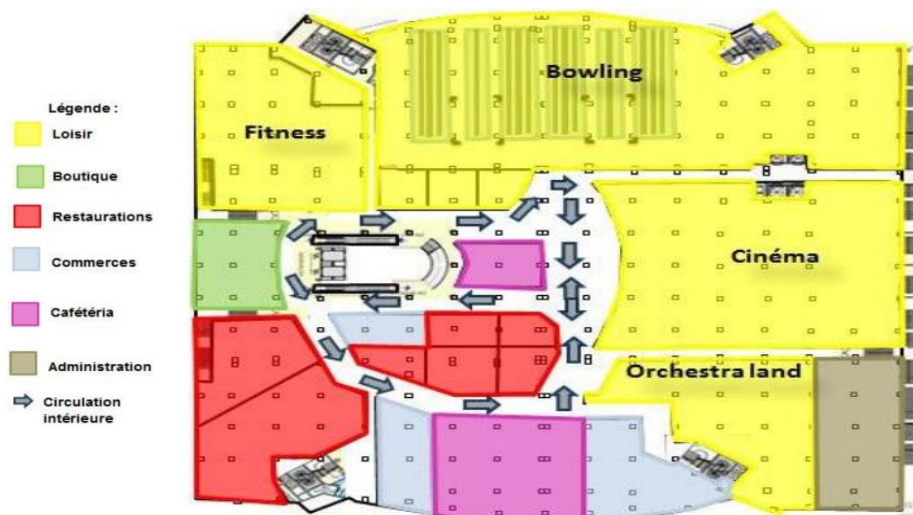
Vue en plan du R+2 du centre commercial de Bab Ezzouar.
